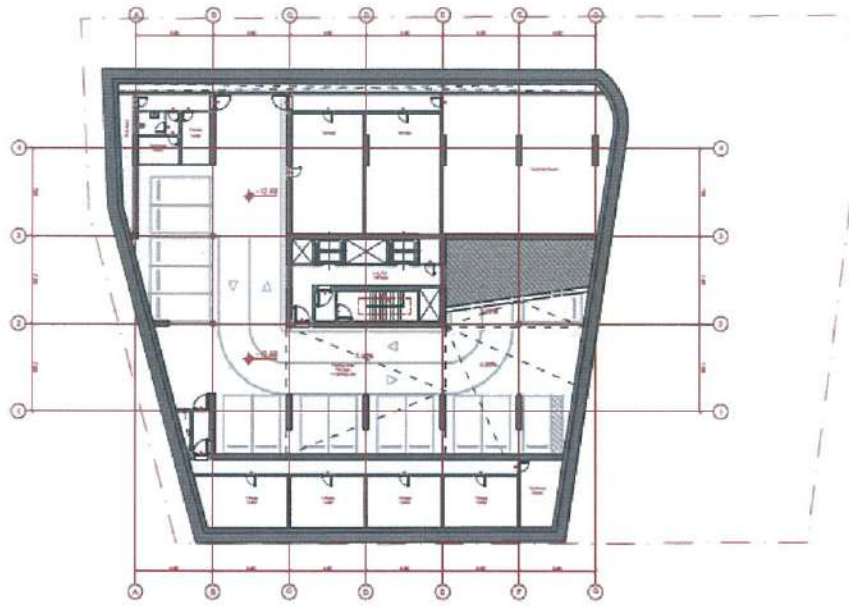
Planimetria e katit -4, në kuotën -12.92 SIP 1 515 m²
